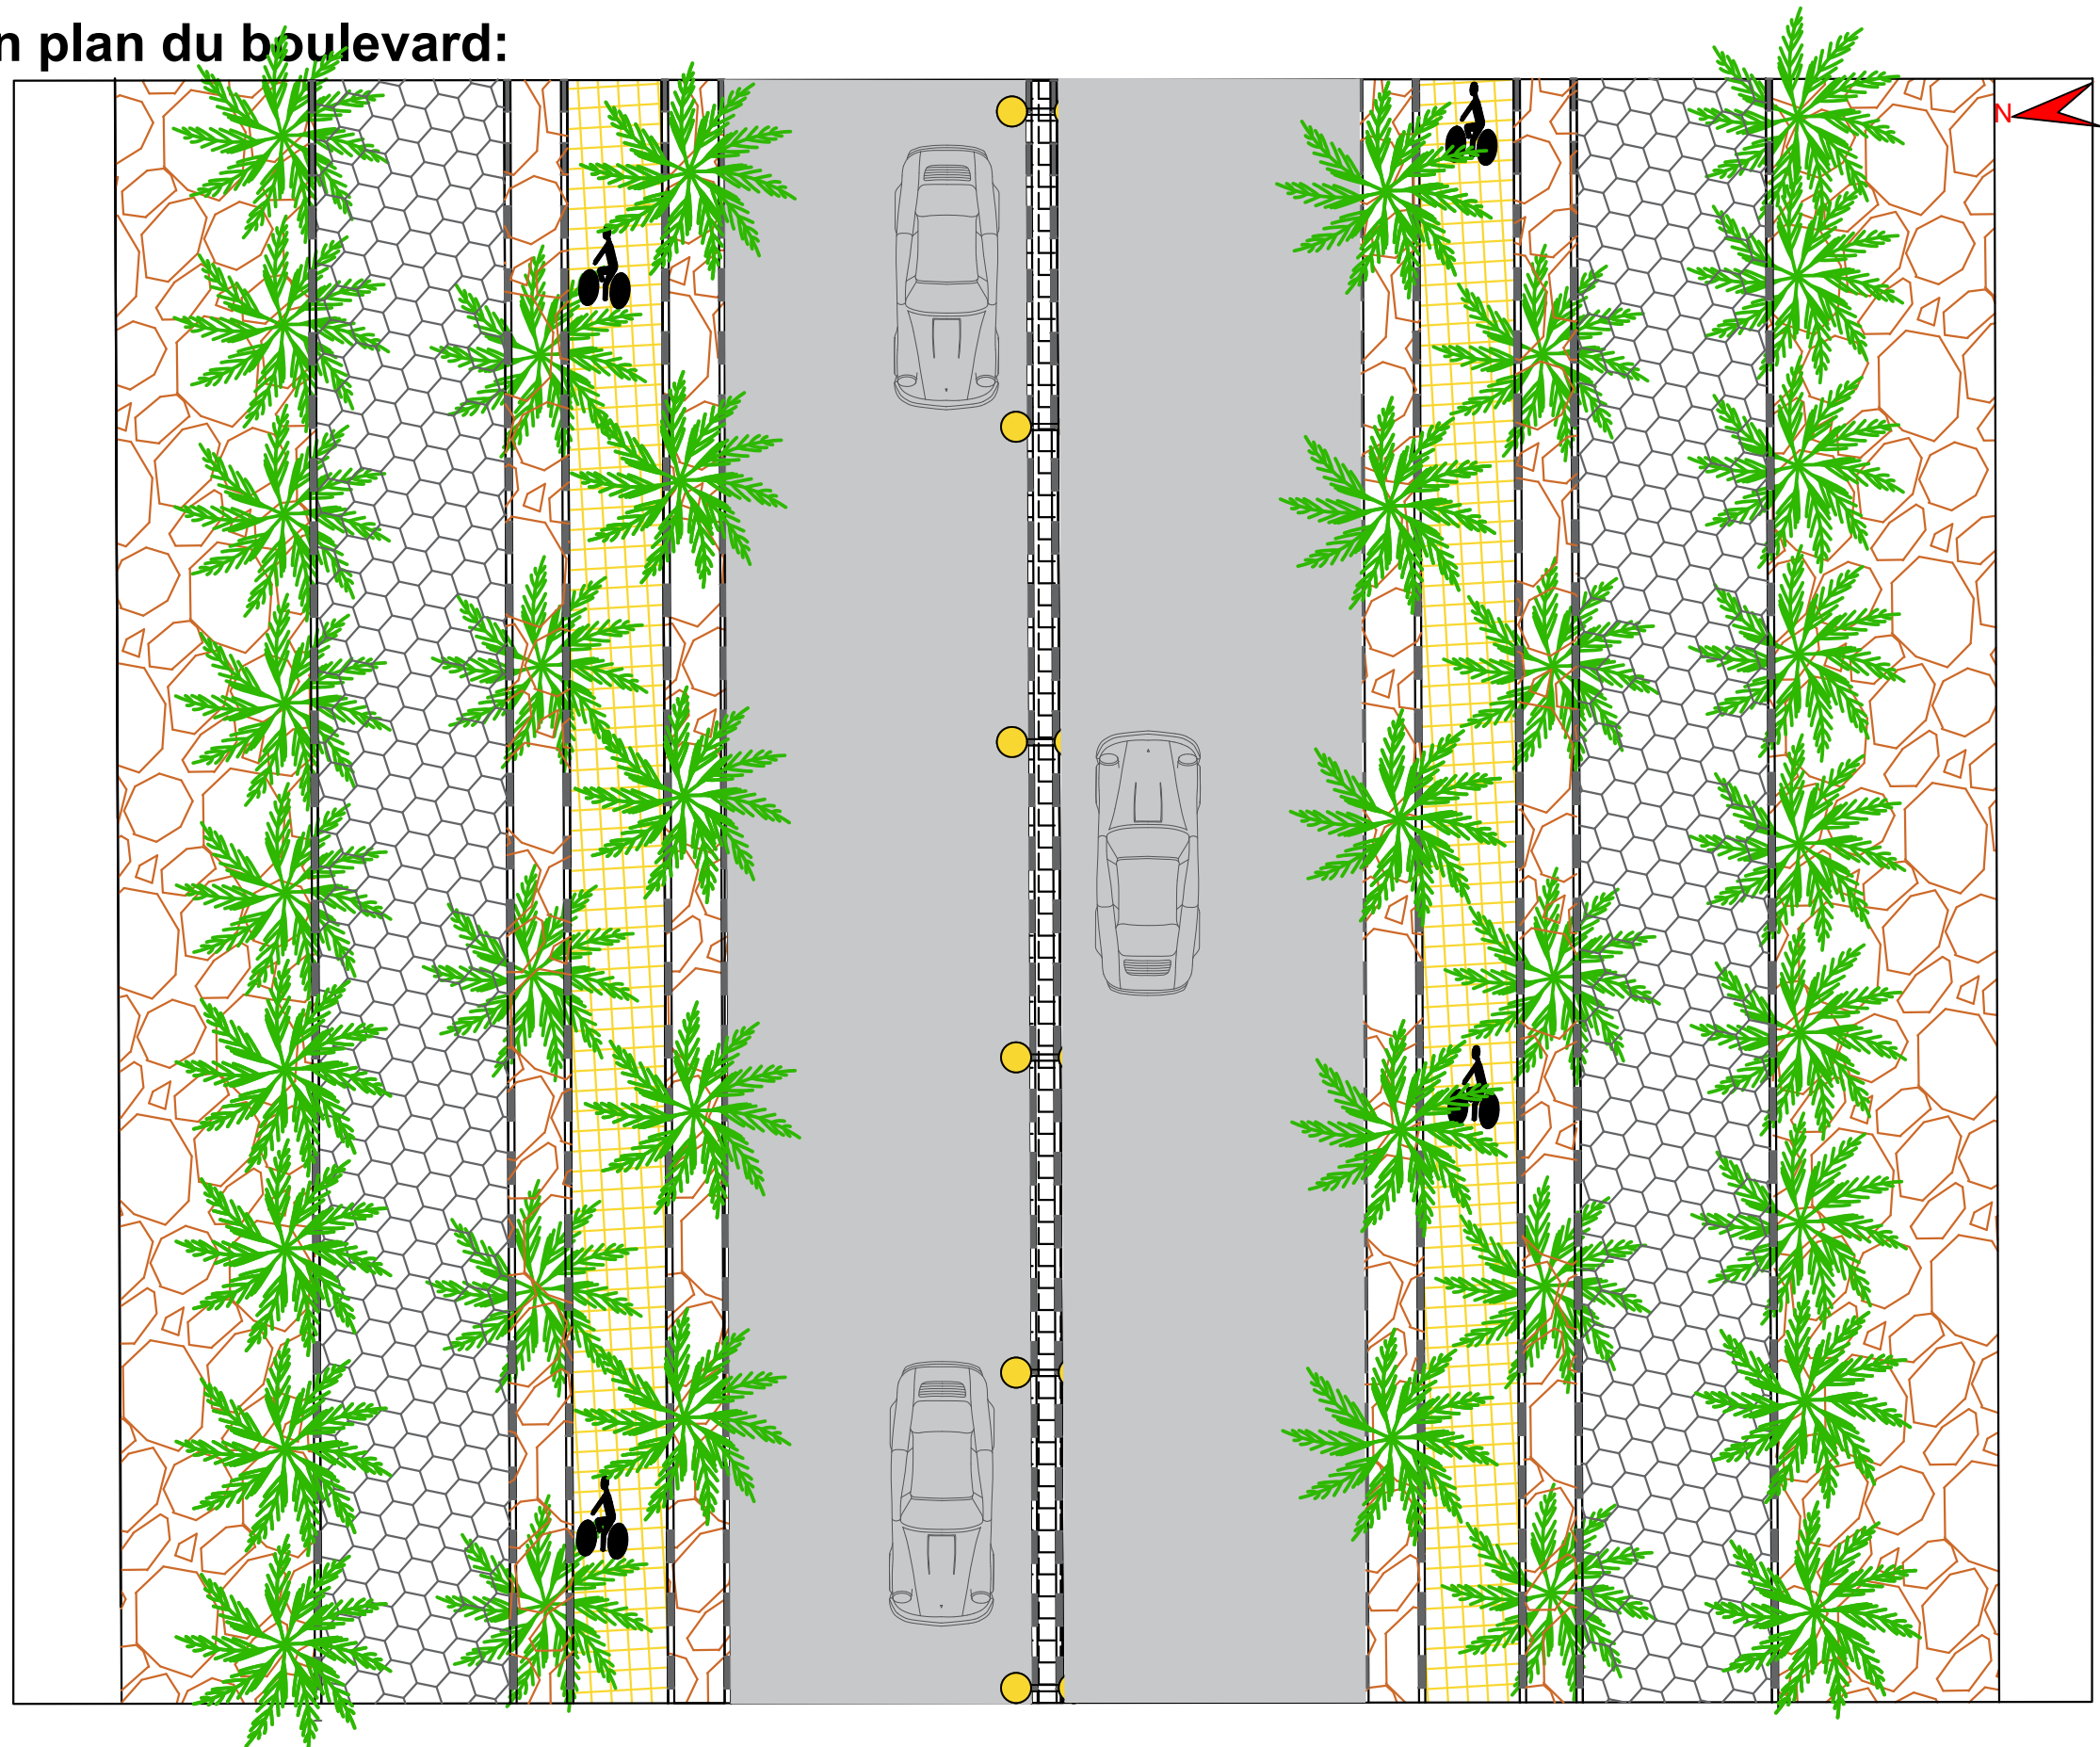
Vue en plan du boulevard / Ech 1/100
